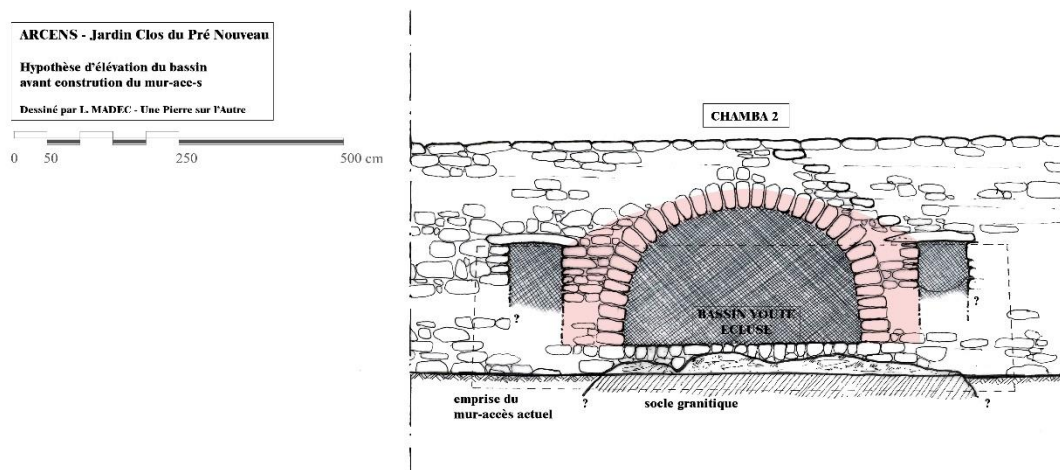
élévation ai niveau de la voute avant construction du mur accès.
